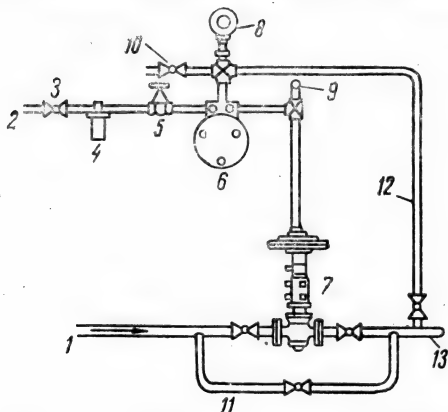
Схема установки регулятора типа РД и исполнительного механизма на газопроводе:
